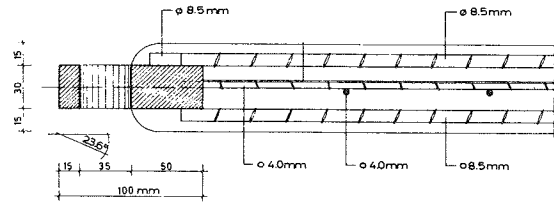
Ejemplos 1 y 2. Disposición de la armadura adicional en los apoyos. Detalle del empotramiento con el marco rígido inferior.
